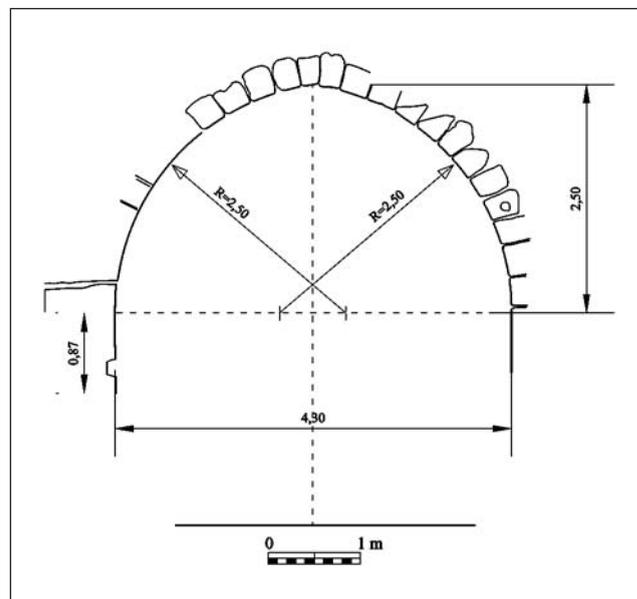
Alzado de arco apuntado del muro medianero entre los solares de la calle Purísima, 21 y Sant Jaume, 36.
